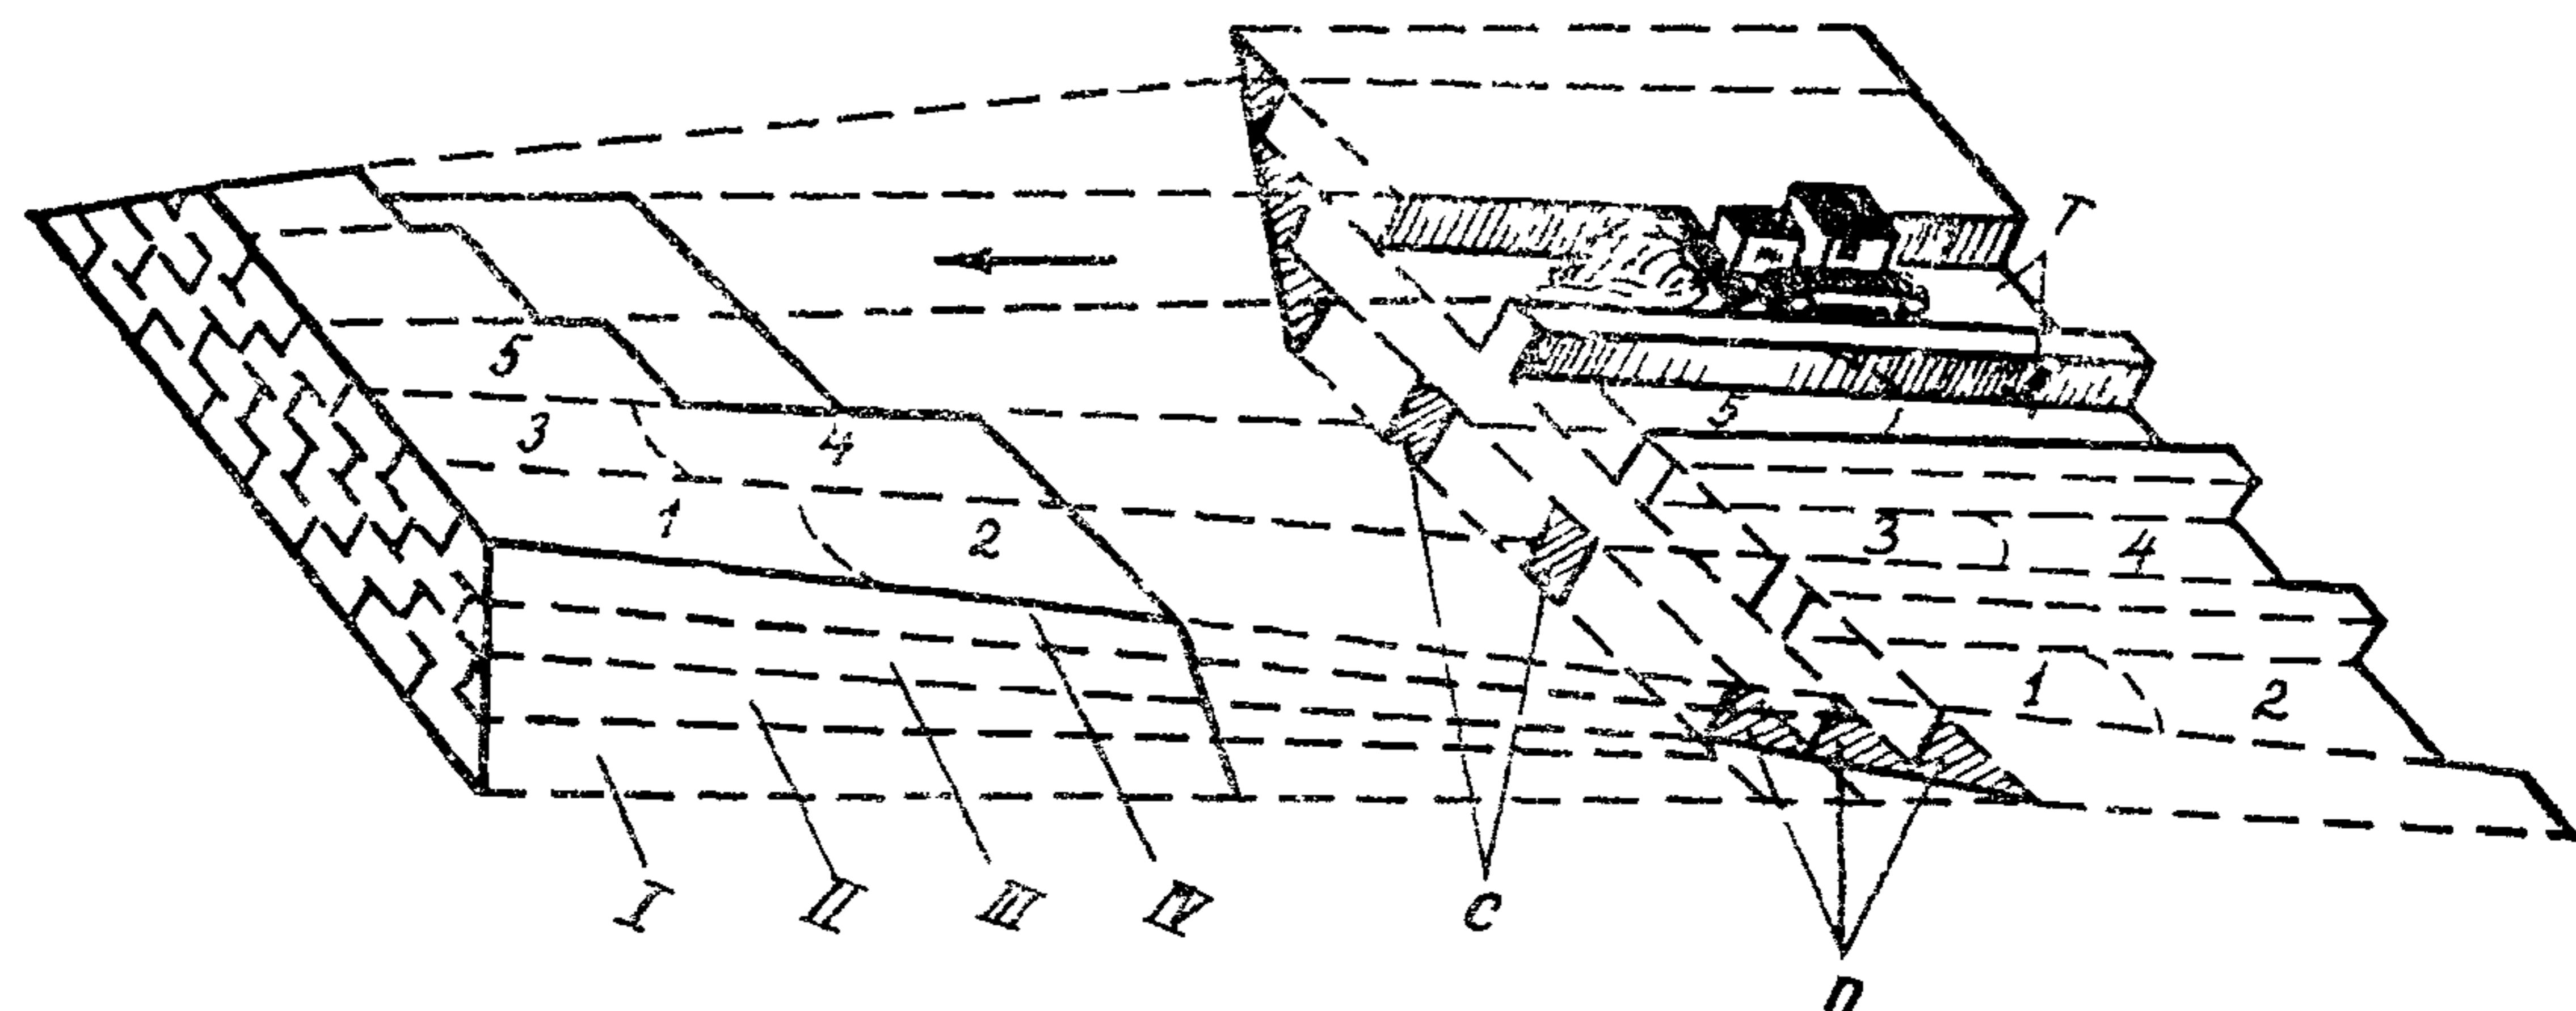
Ярусно-траншейная схема разработки бульдозером грунта
